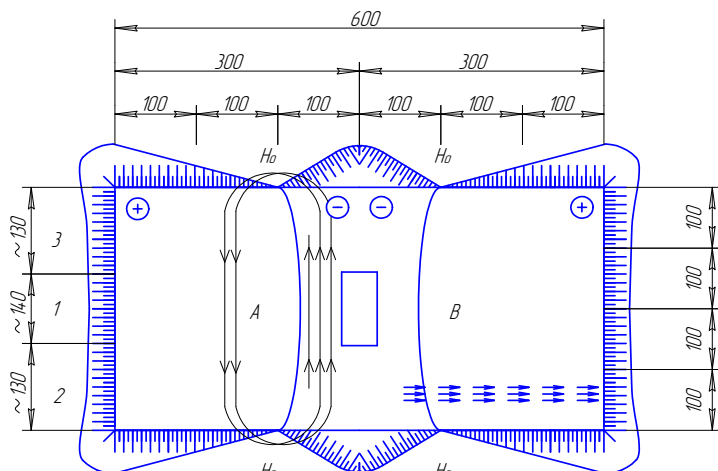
Примерная схема производства планировочных работ строительной площадки при делении на два равных участка:
